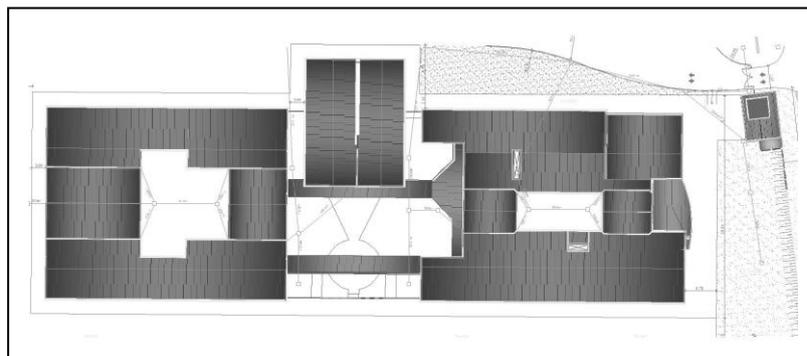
Planta de Implantação esquemática do IFBA Vitória da Conquista.
